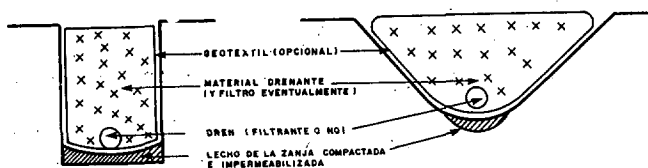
Lecho de zanja compactado e impermeable. (Sección tipo de zanjas drenantes).
